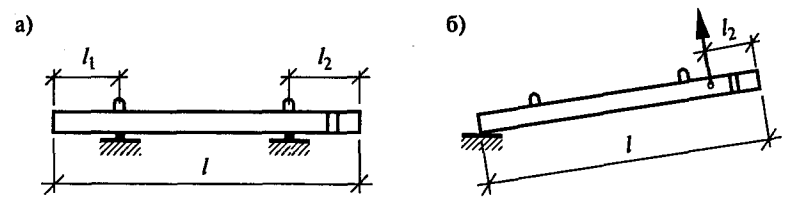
а) — схема складирования (транспортирования колонны); б) — схема монтажа колонны
